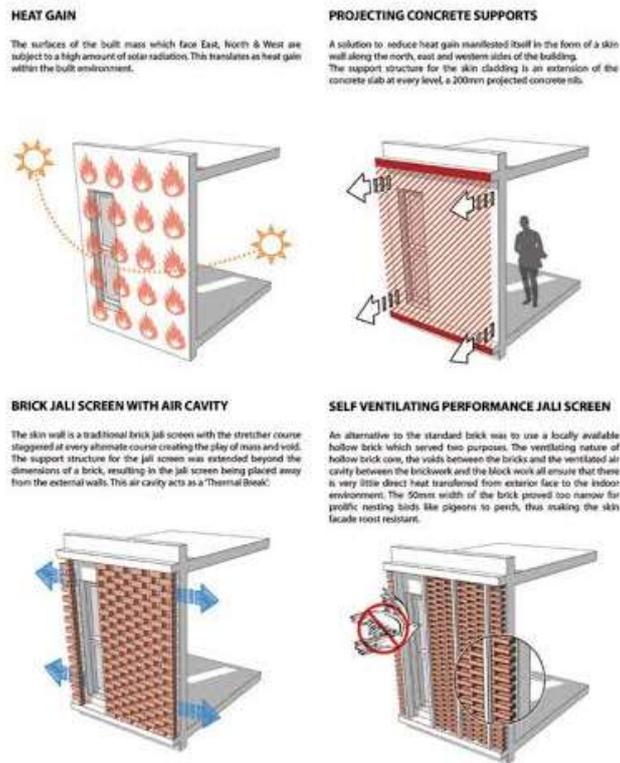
Mur en brique détail constructif, Source : auteur, 2021
